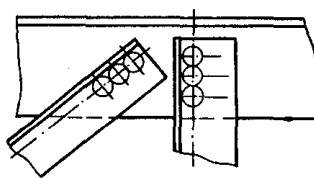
Бесфасоночный узел стропильной фермы, выполняемый контактно-дуговой точечной сваркой
